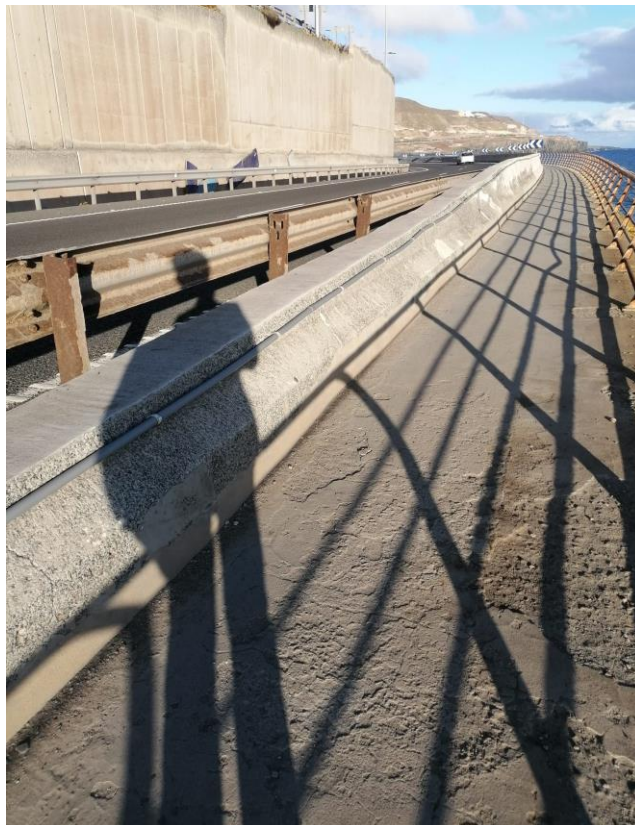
Perforaciones en la barrera para permitir el drenaje de la vía
